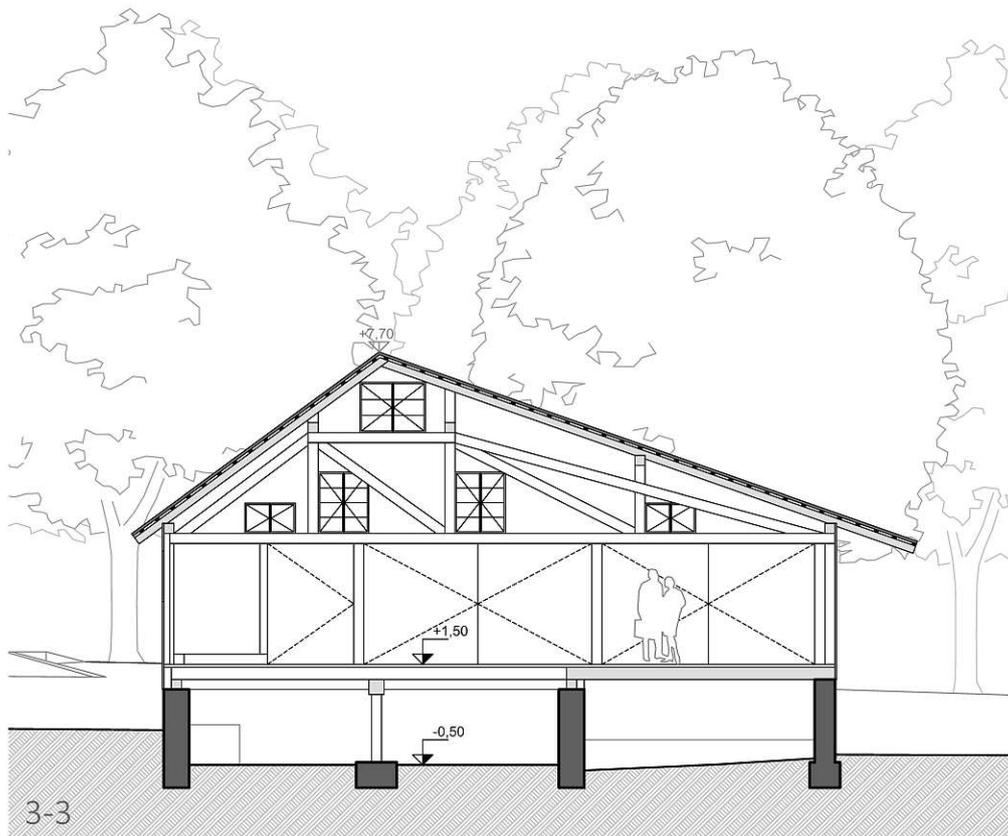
Schnitt Sägwerk 3-3– Bestand, Maßstab 1:150.
